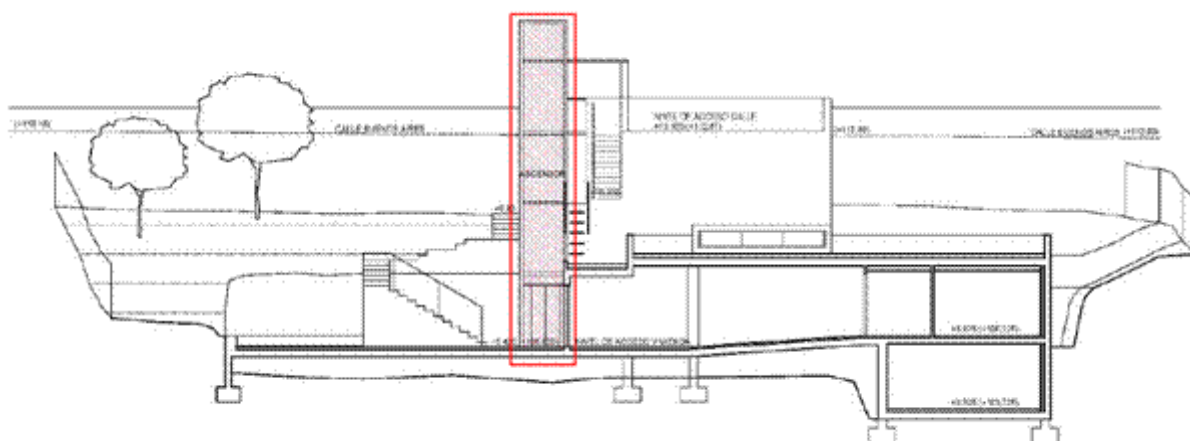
Secció-alçat de la planta superior d'accés de l'habitatge i de la plataforma d'aparcament existent i l'ascensor proposat.
